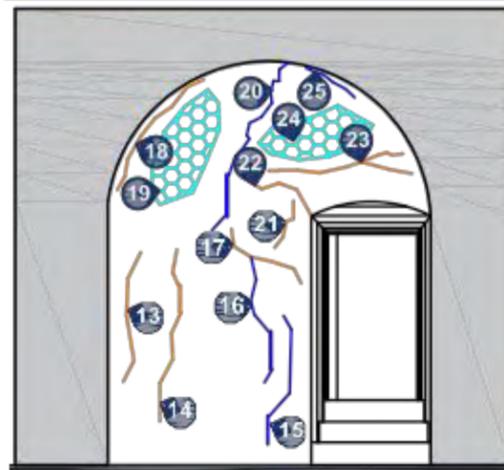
Vista de deterioros existentes en parte alta de muro interior norte
